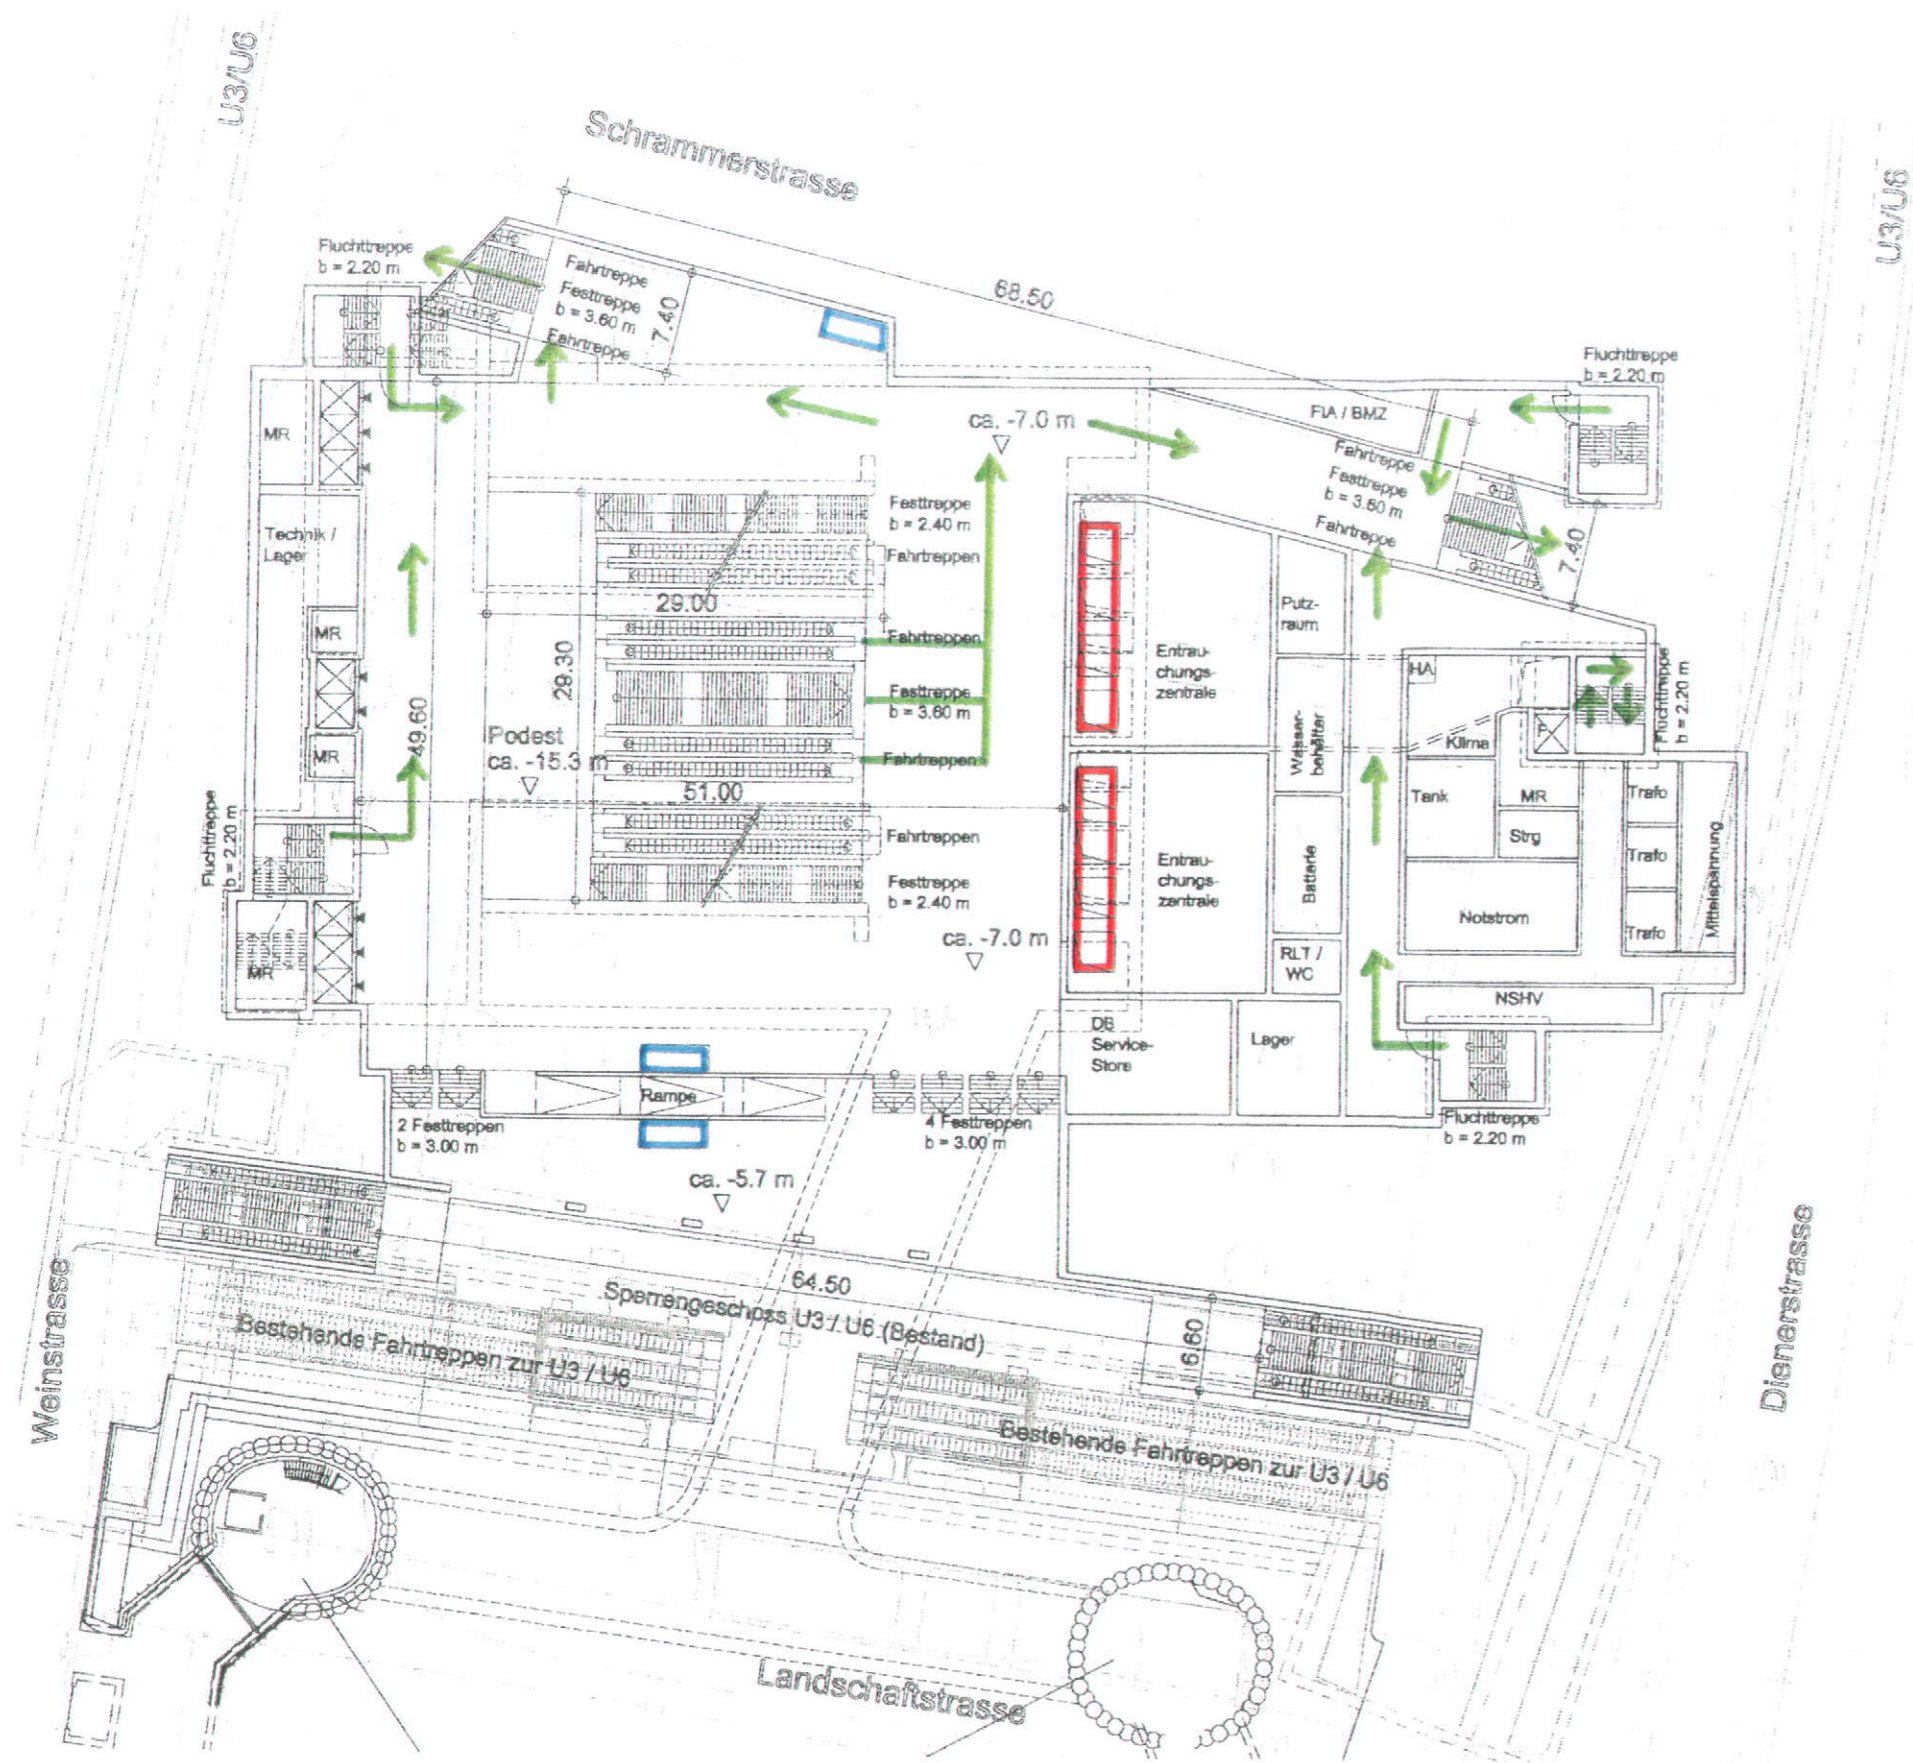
Grundriss Sperrgeschoss mit brandschutztechnische Einrichtungen
